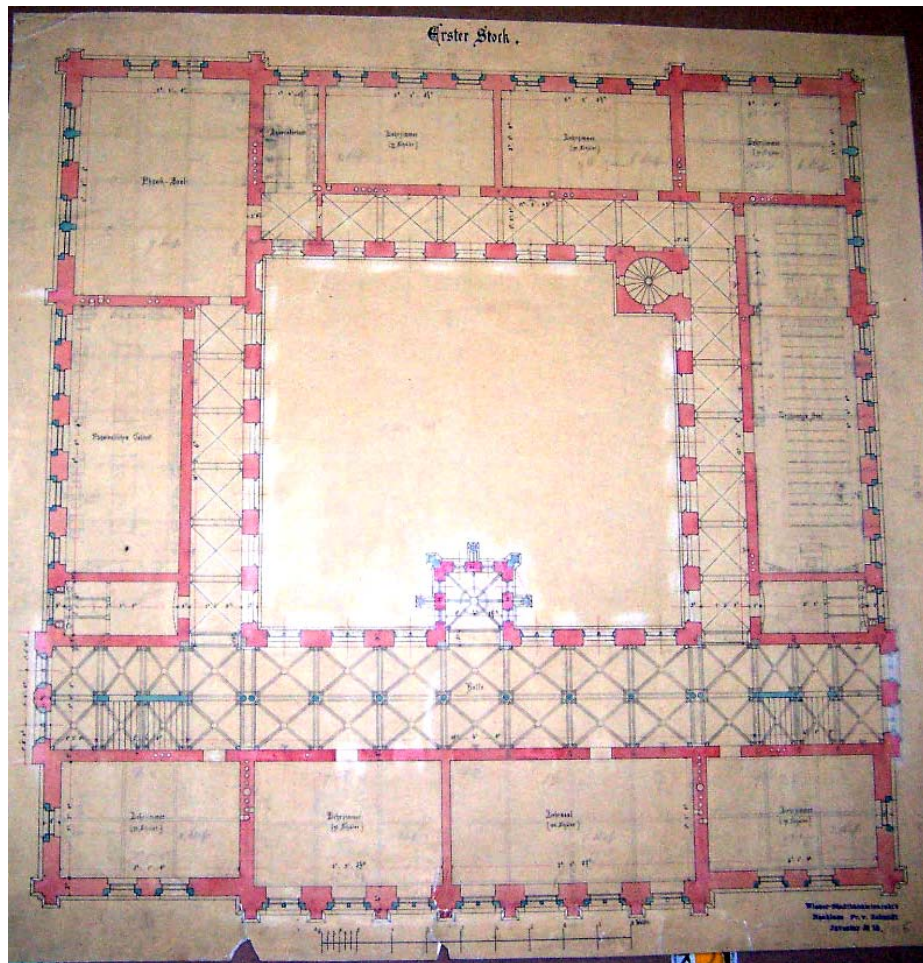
Grundrissplan, Erster Stock, nach 1862
